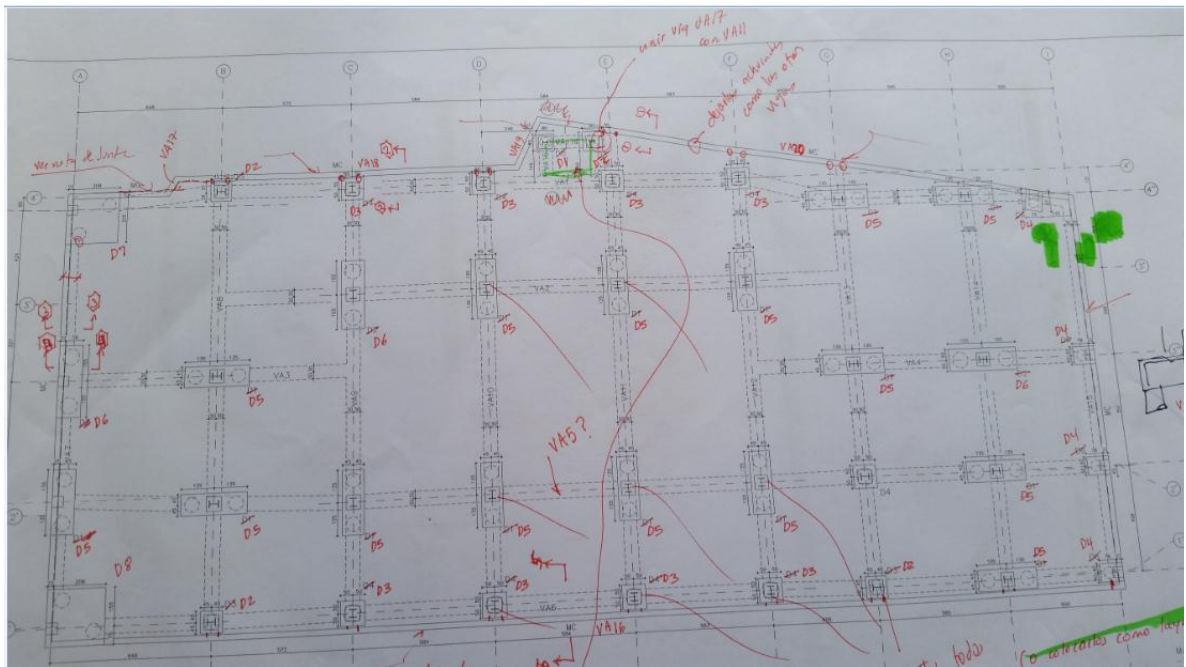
PLANTEAMIENTO INICIAL DE PLANTA DE CIMENTACIÓN PARA FOSO DEL ASCENSOR.
